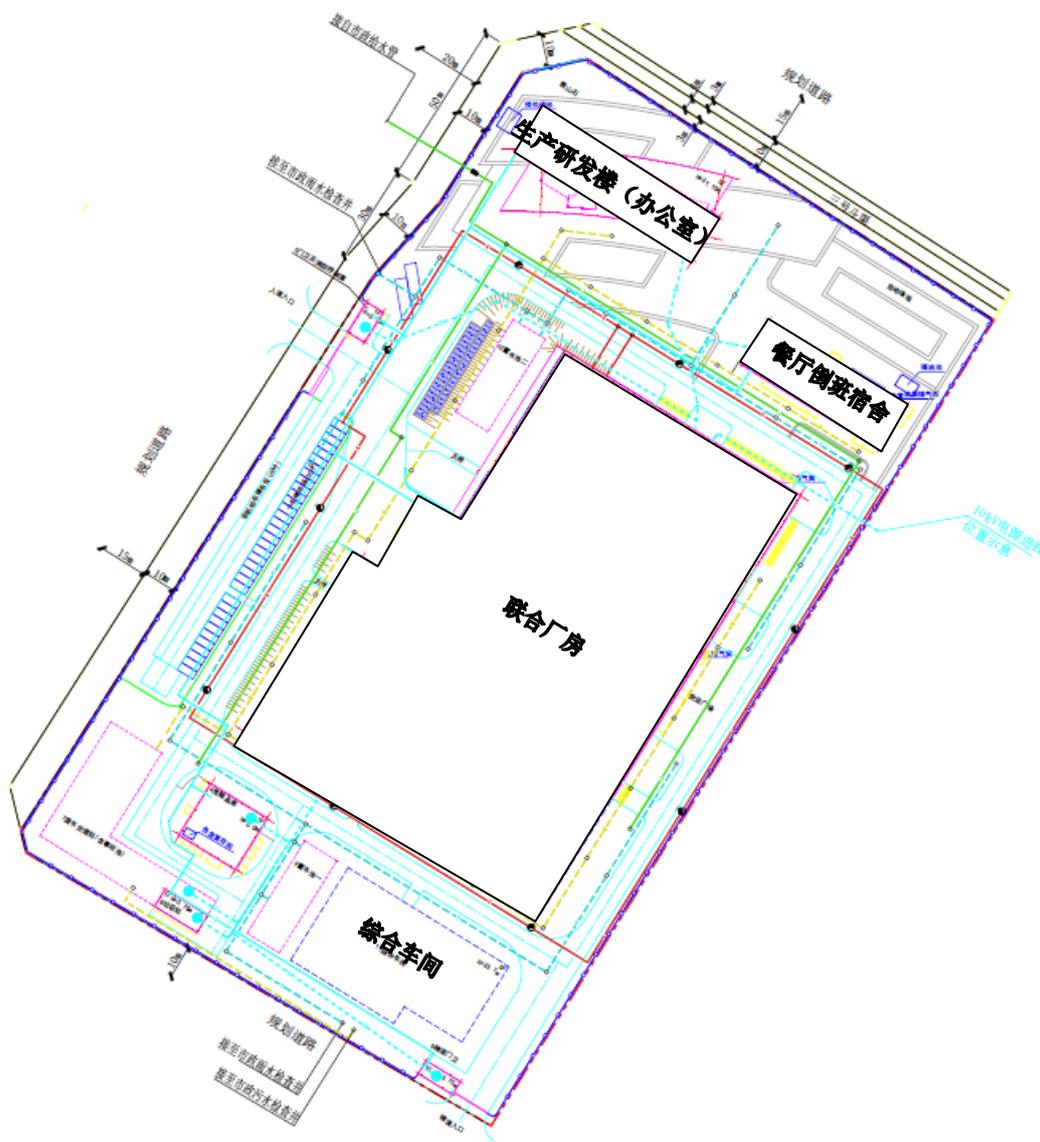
海锐特药业创新性吸入药物产业园总平面布置图
